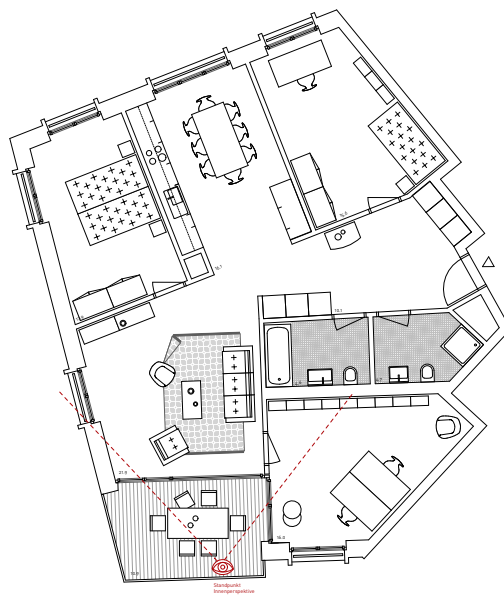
Rivo di Colla: Wohnung 4.5-Zimmer
